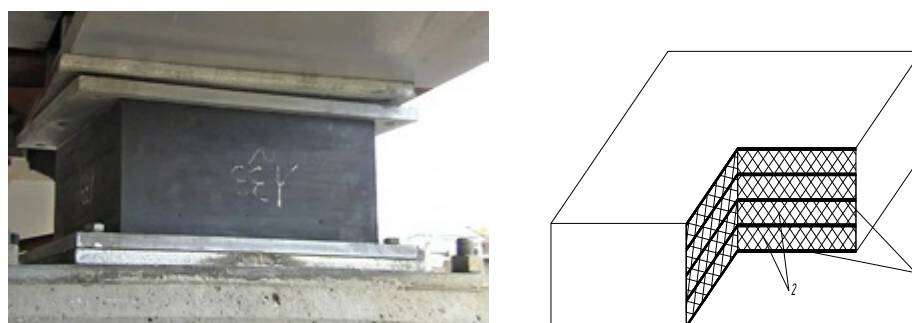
РОЧ: *a* — вид РОЧ; *b* — конструкция
